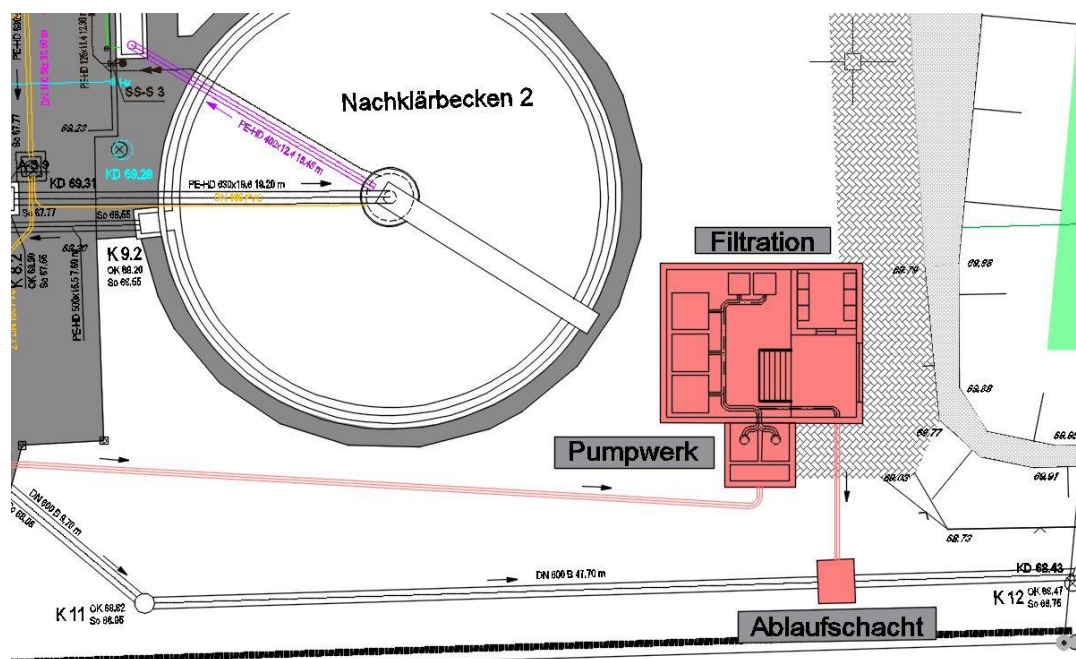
Anordnung der erforderlichen Bauteile für Variante 1a im Lageplan
